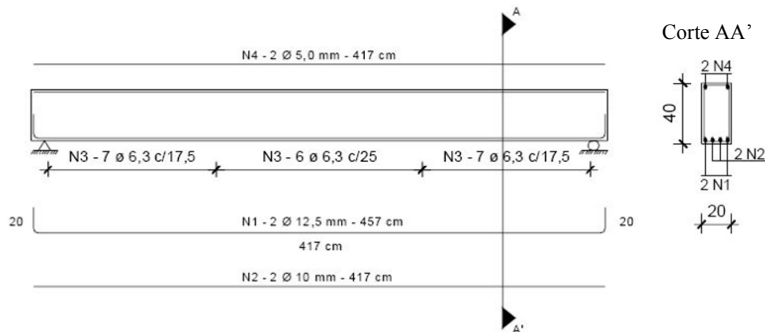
Armadura da viga VR (MACHADO, 2004)
